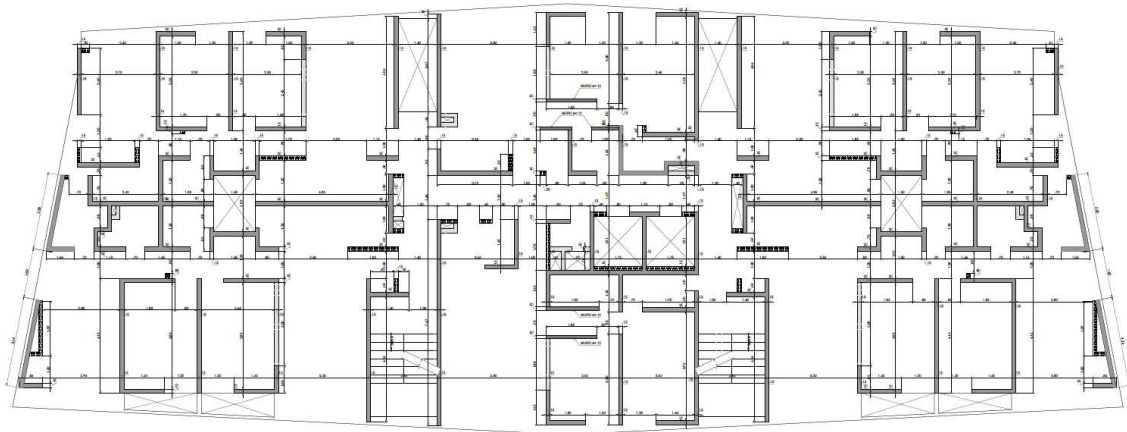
Planta Estructural Pisos 1 a 6, muros $e=0.15$ m. Fuente: Elaboración propia.
